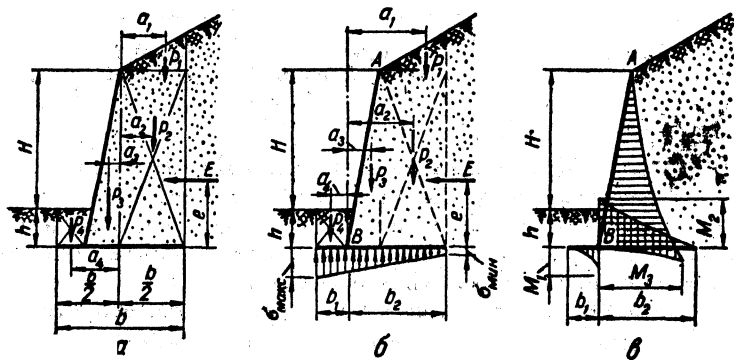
Расчетные схемы железобетонных подпорных стенок: а — расчетная схема для определения напряжений на грунт; б — расчетная схема для определения моментов в консольных плитах; в — эпюра моментов в консолях.
